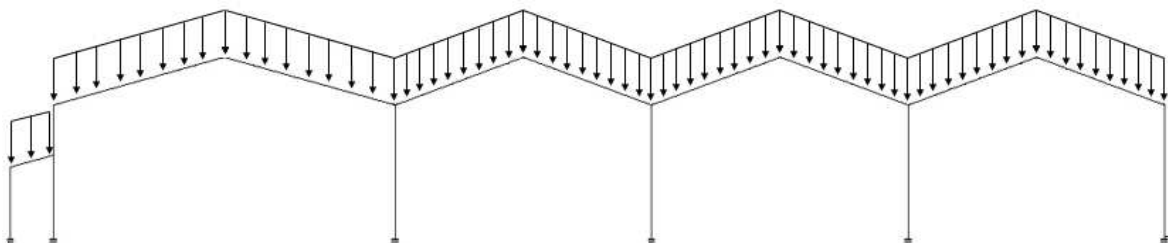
Distribución de las cargas sobre la cubierta de las naves.
